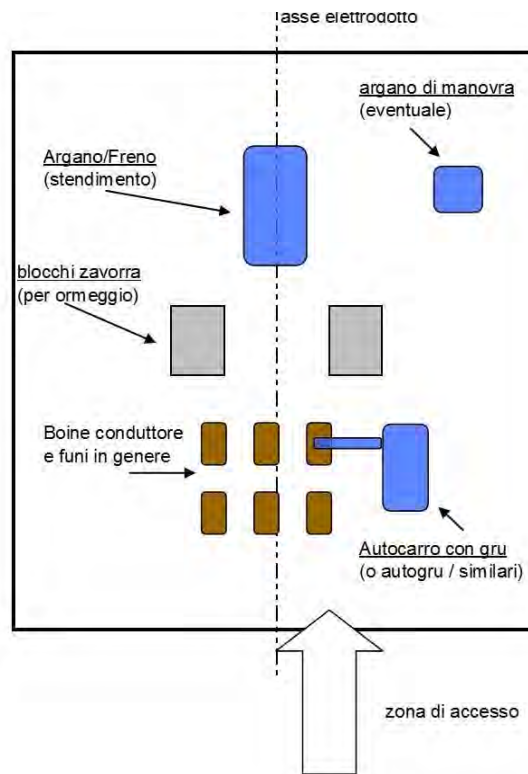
Planimetria dell'Area Sostegno (montaggio sostegno) - Planimetria dell'Area di linea - Tipologico
